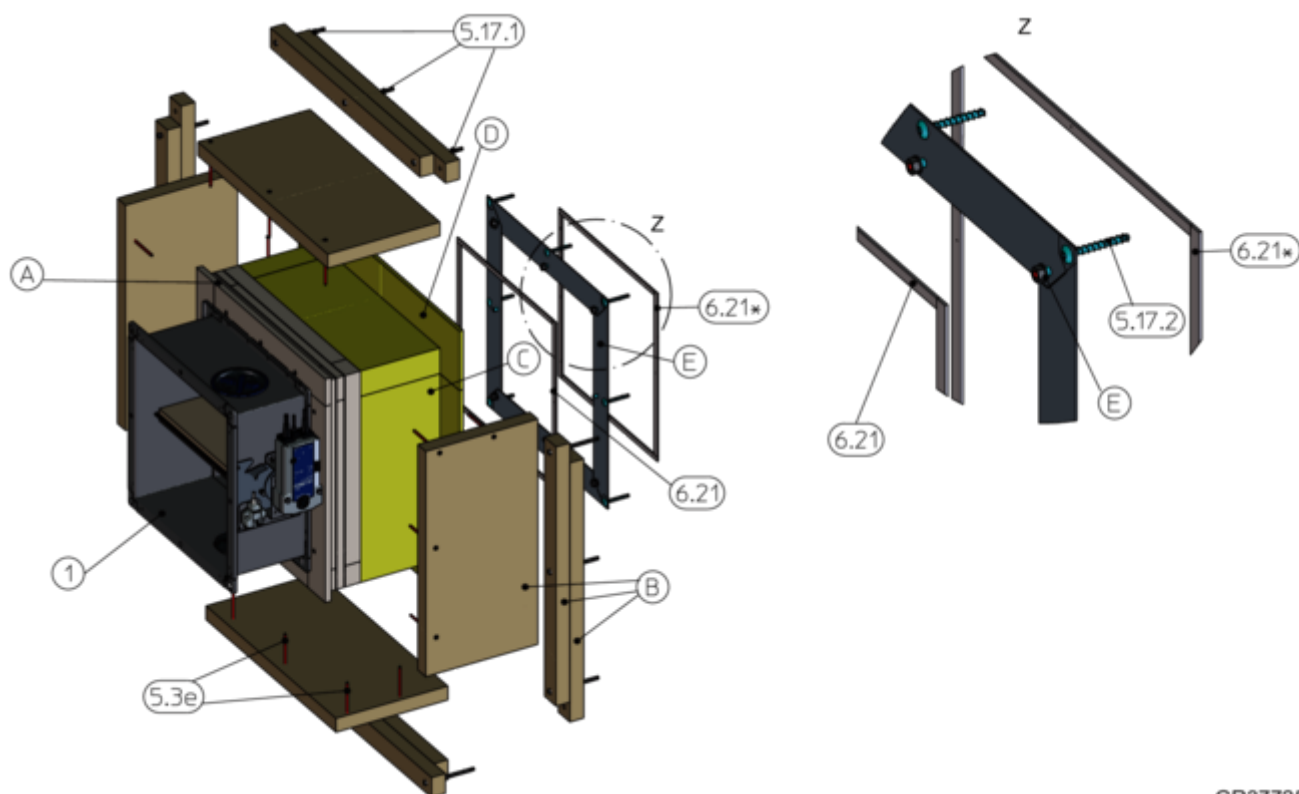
Installationskit WA för torr installation utan murbruk - montering
